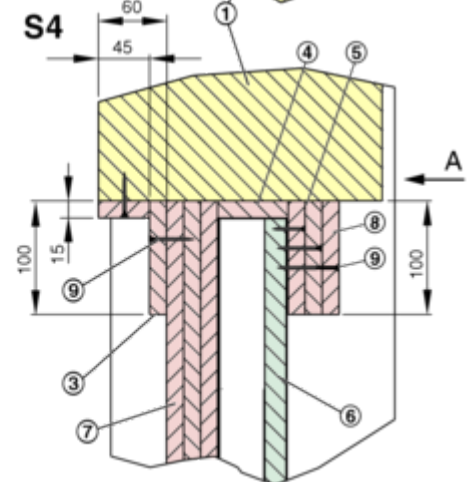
Details EK-JZ Trockeneinbau in Gypsum Wall mit Metallständer EI 120 S
